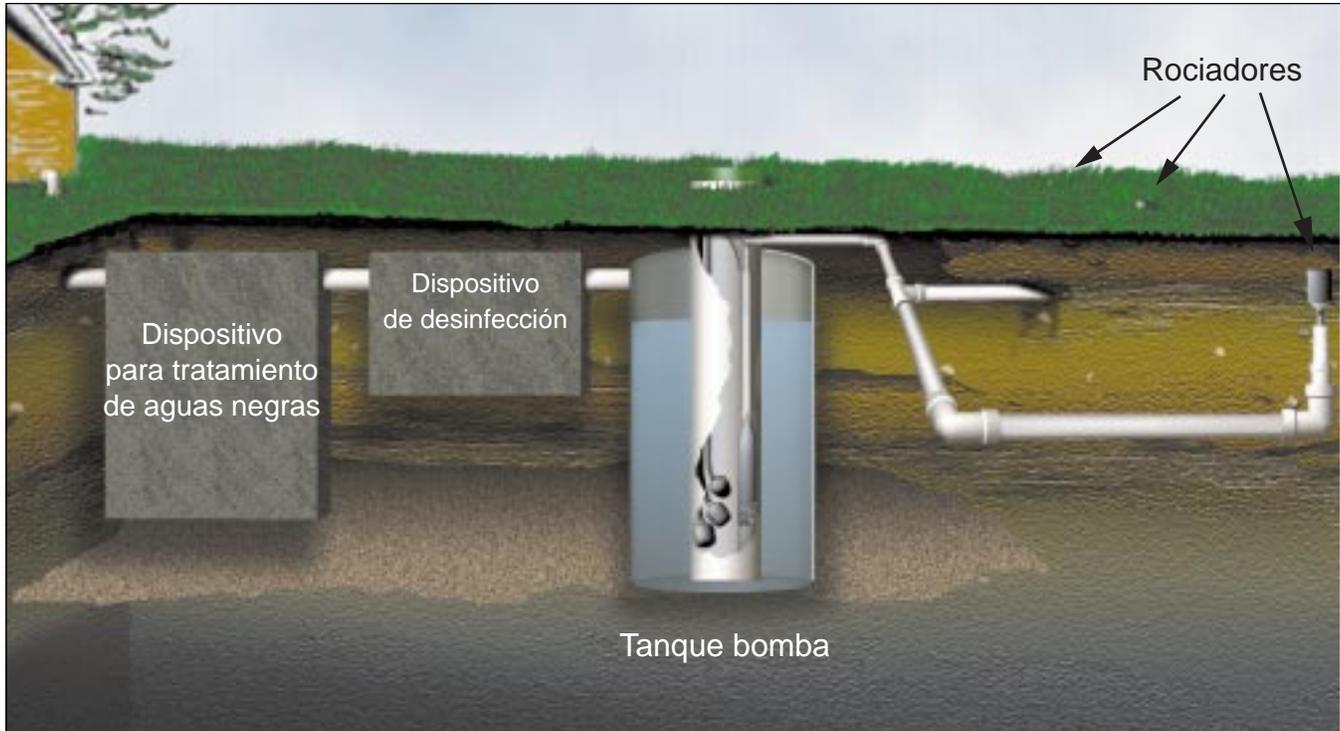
Un sistema de distribución por rociado con dispositivos para tratamiento y desinfección.
